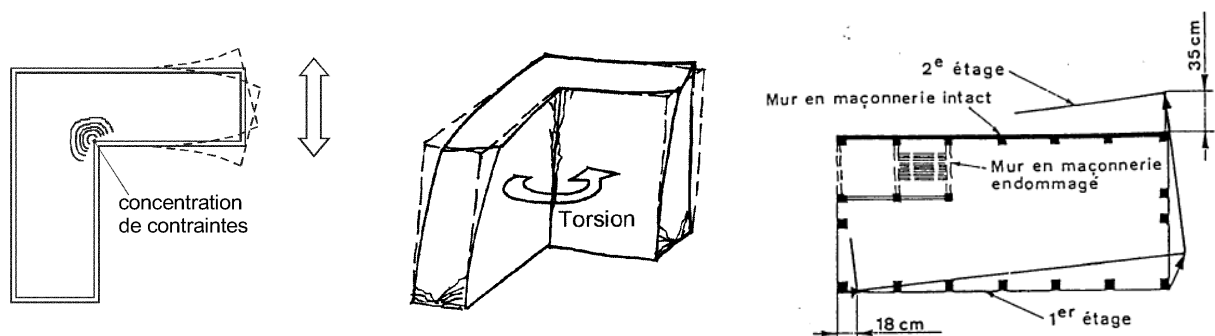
Déformation d'un plan irrégulier en plan [1].
